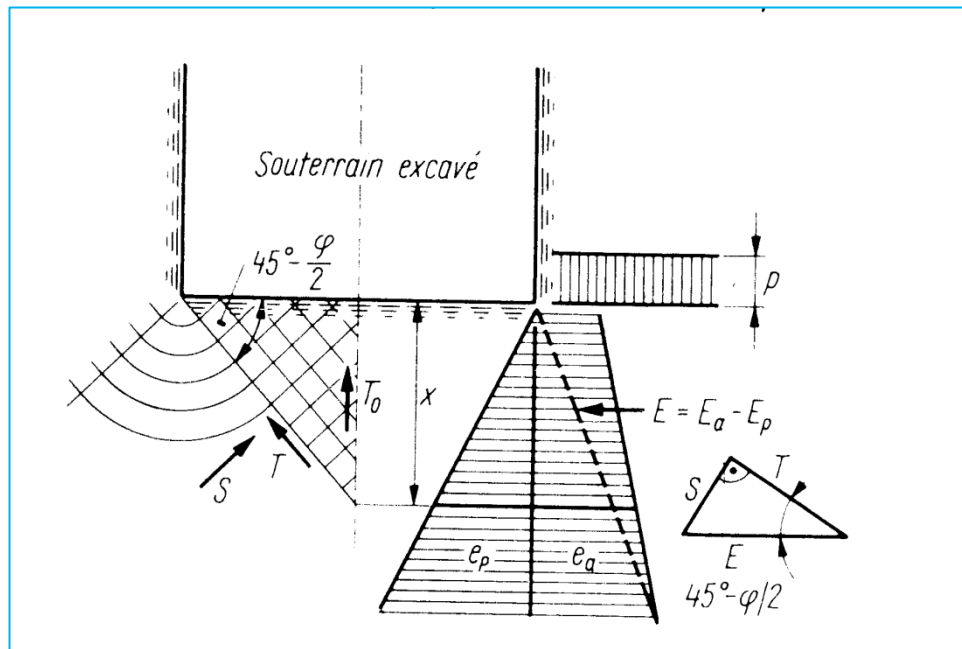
calcul des poussées du radier d'après Tsimbarievitch.
